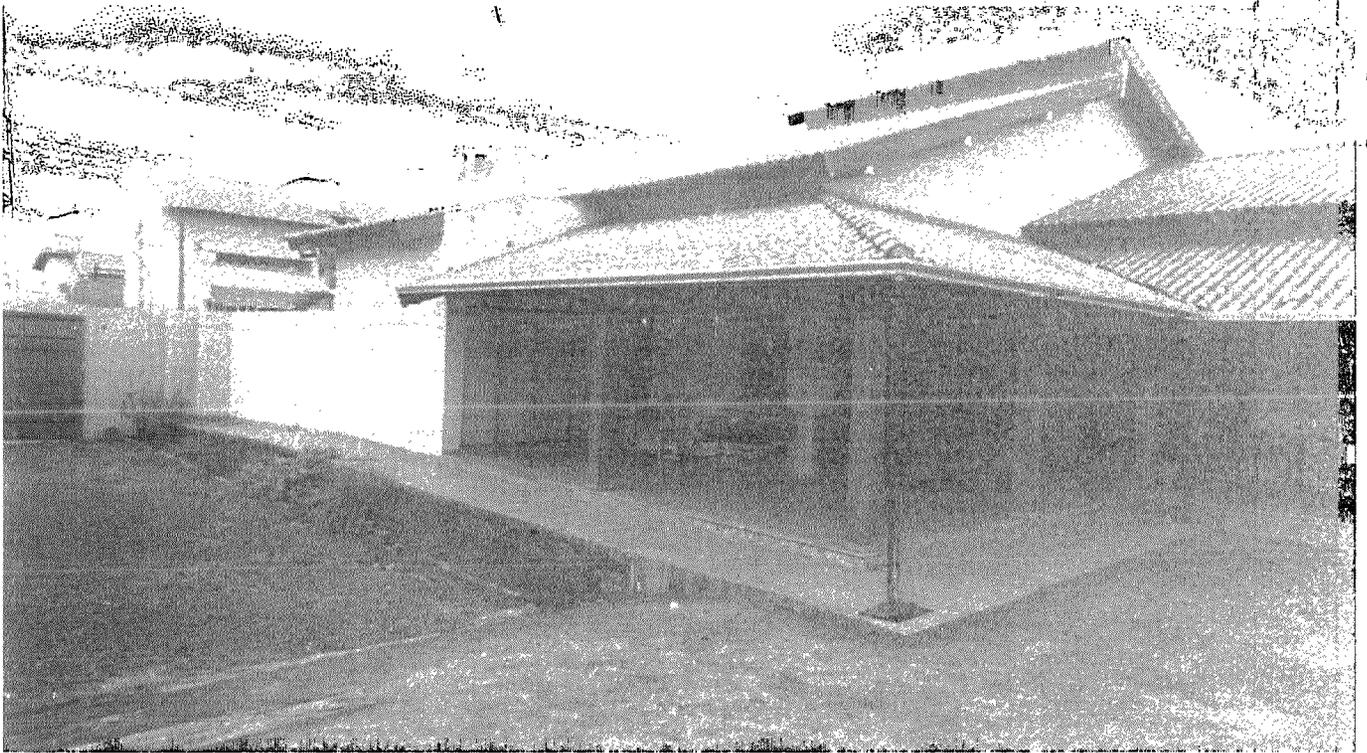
Benfeitorias construídas no imóvel penhorado - alto padrão construtivo.
